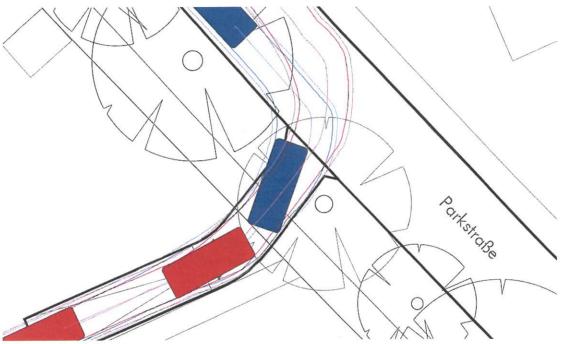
Prüfung der Befahrbarkeit der geplanten Tiefgaragenzufahrt (blau: Einfahrt/ rot: Ausfahrt) (Ausschnitt aus Bebauungsplan, Architekturbüro Bernhard von Wallis, 22.10.2021)
